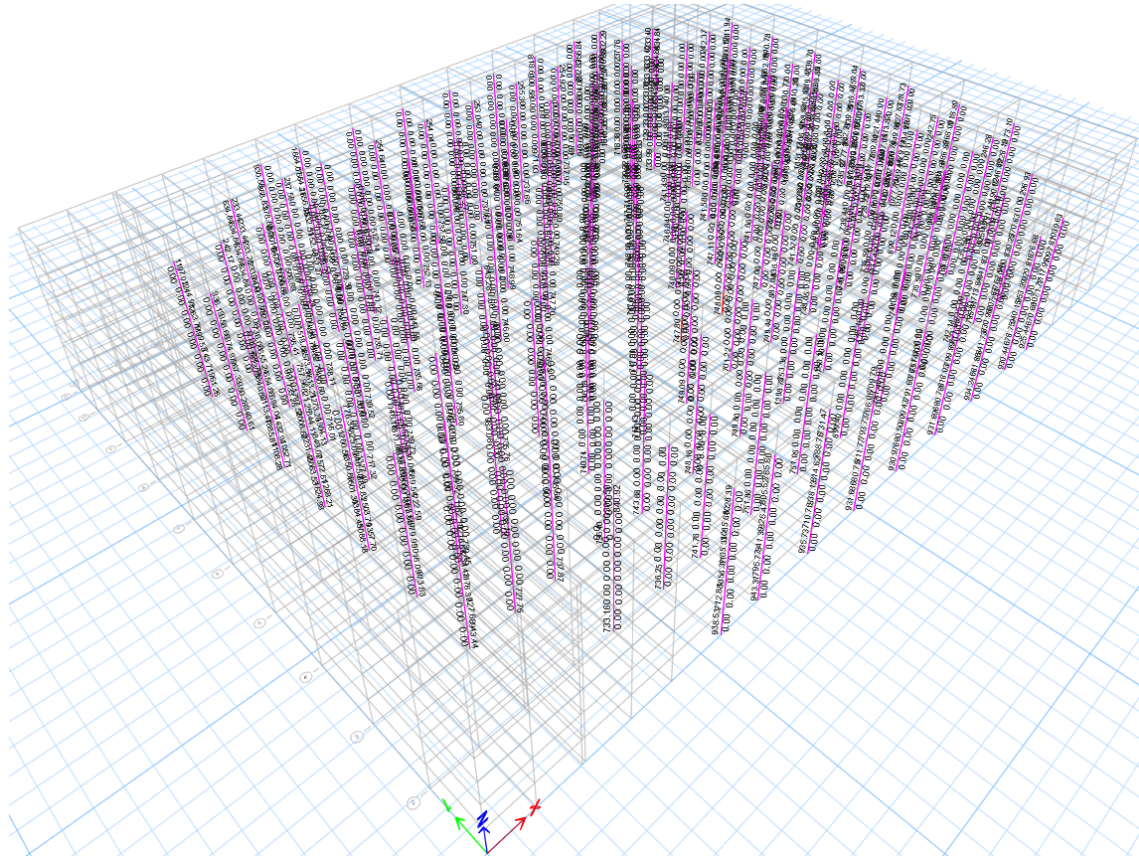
Sipërfaqja e armimit të stafave për kolonat [mm²/mm], ndërtesa e parkimit
